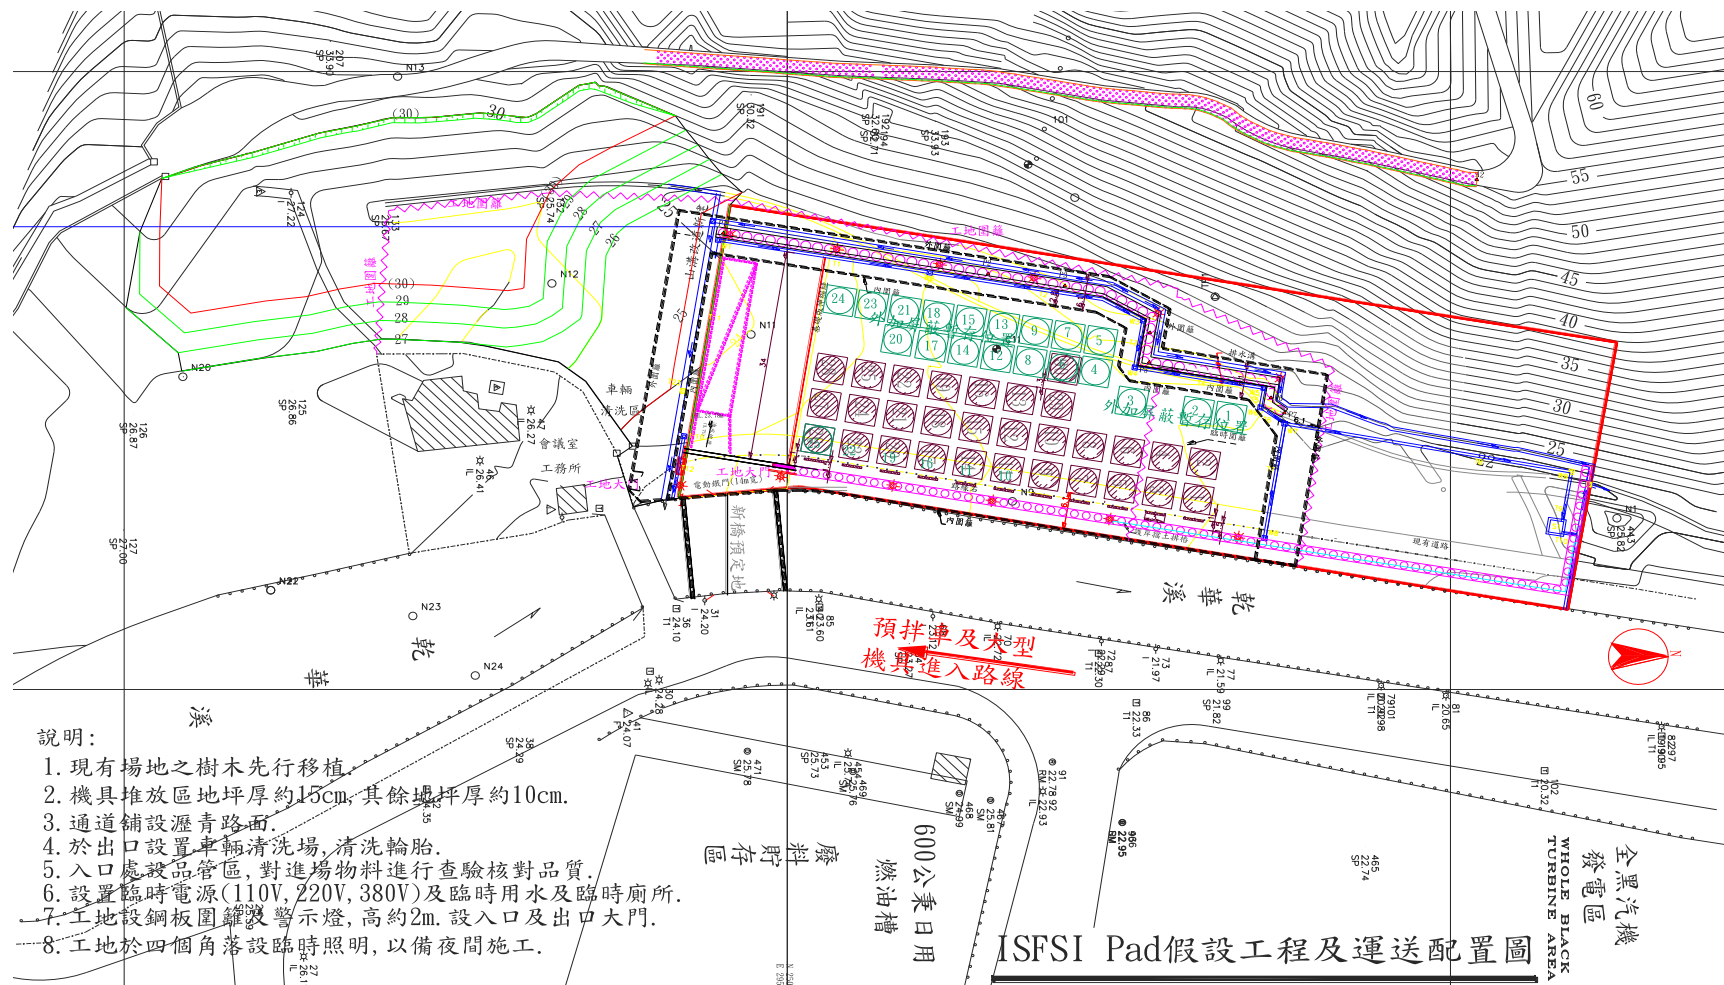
貯存場混凝土基座假設工程及運送配置圖
